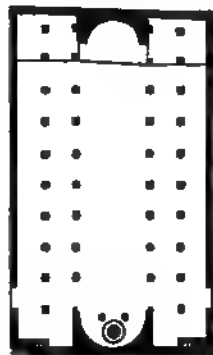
Grundriss der Basilika zu Orléansville
